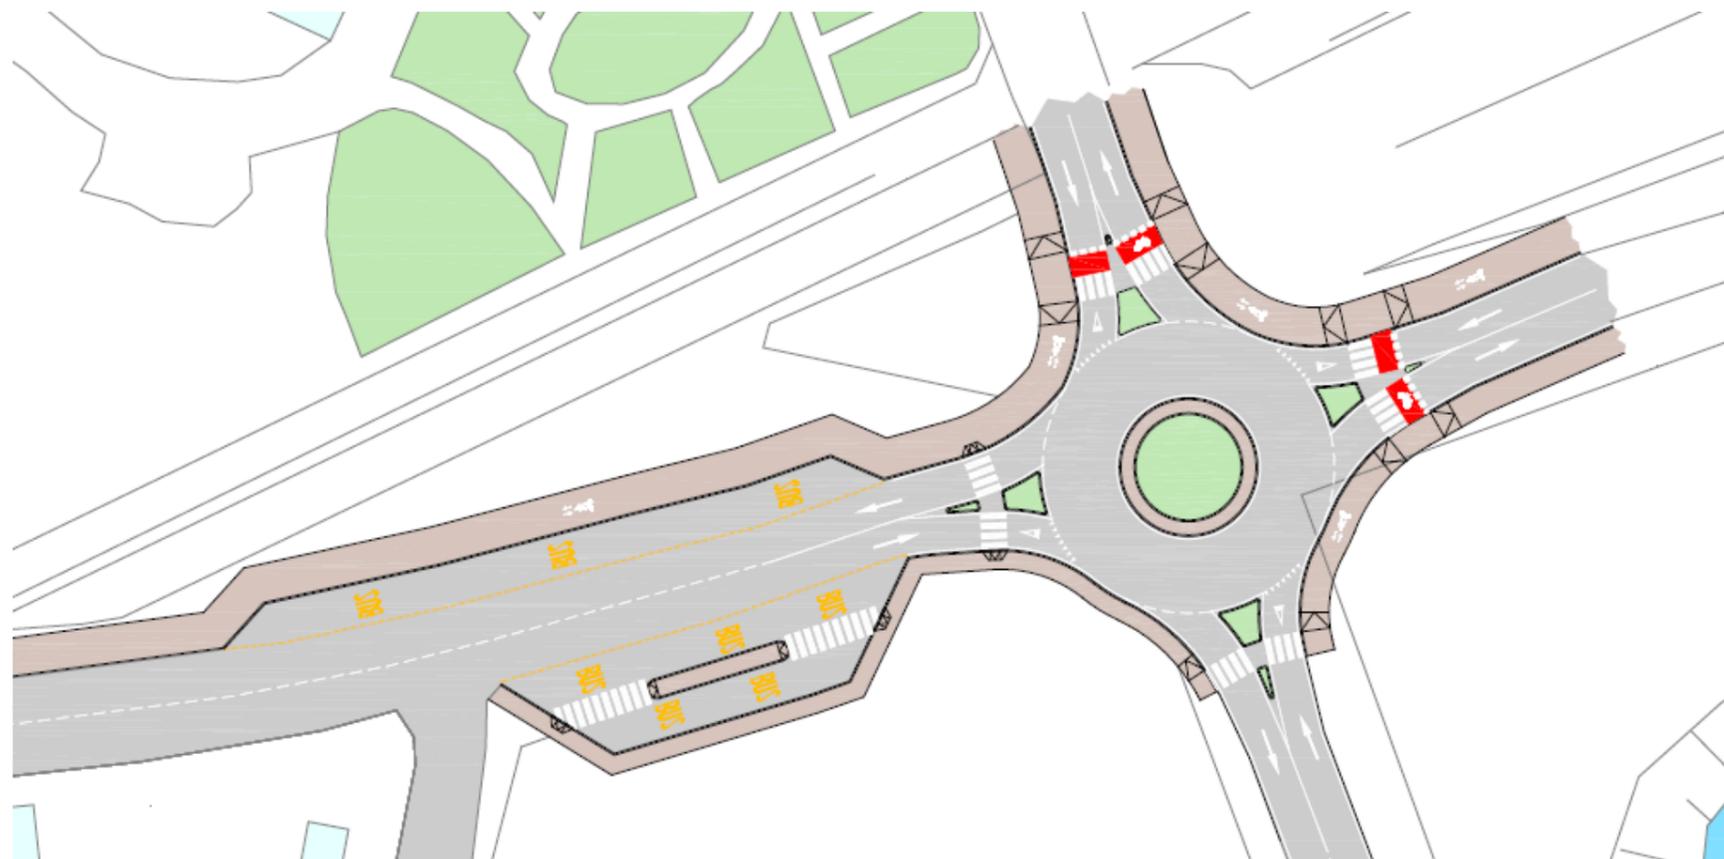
Ipotesi di riorganizzazione dell'intersezione tra S.S.50 e via Achille Gaggia fronte ospedale
